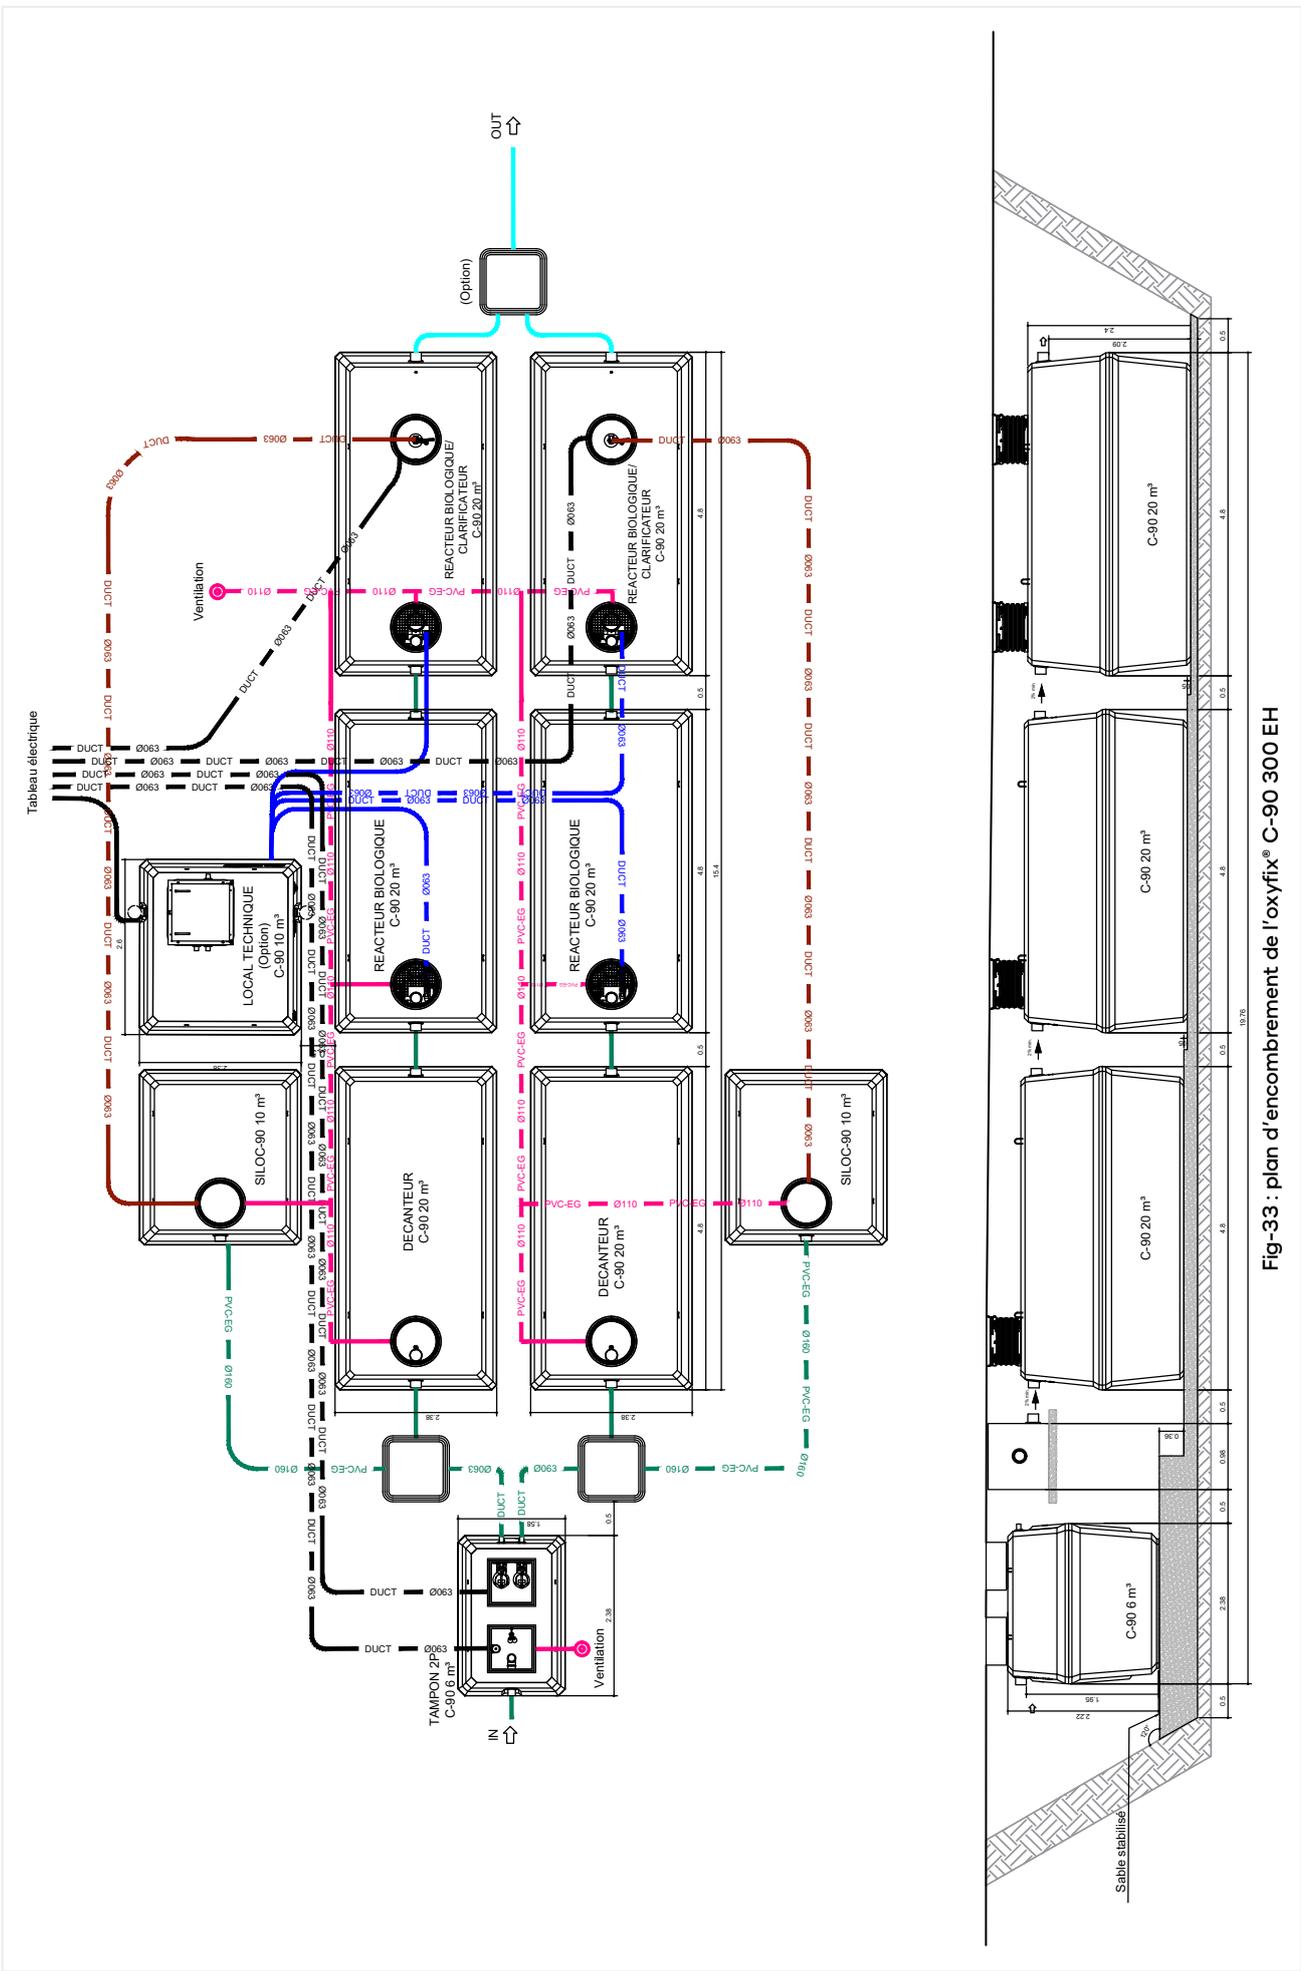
plan d'encadrement de l'oxyfix® C-90 300 EH
